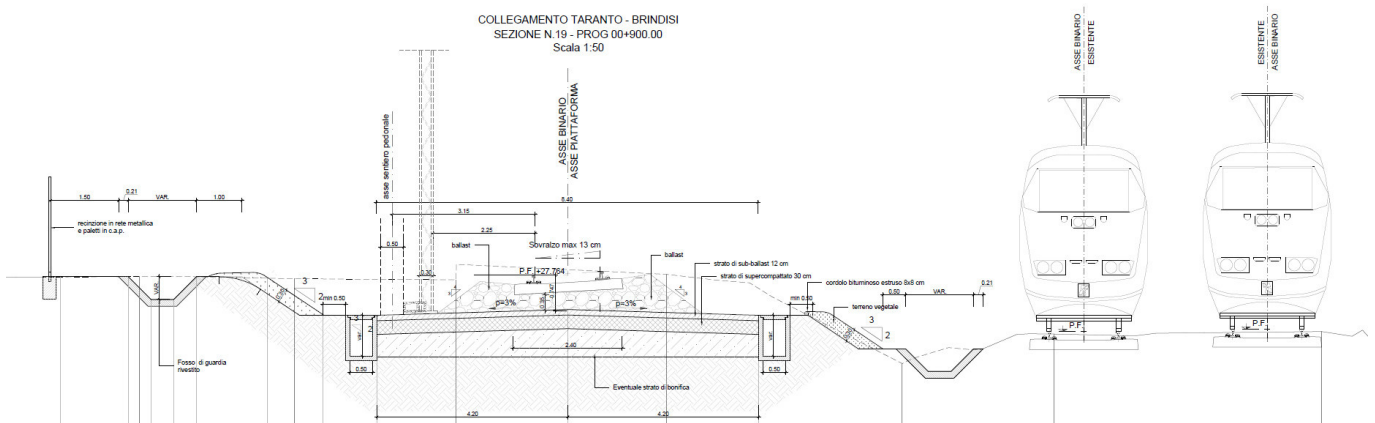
Sezione tipo stretto affiancamento Raccordo Taranto – Linea Bari-Lecce
